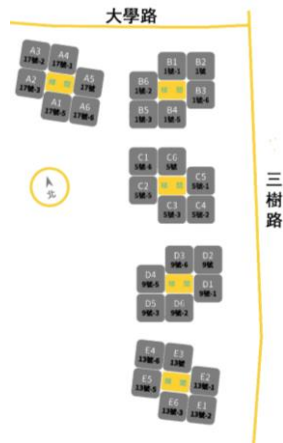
、總平面圖 圖 3、青銀共居選用樓層佈局 圖 4、原居住單元平面圖
